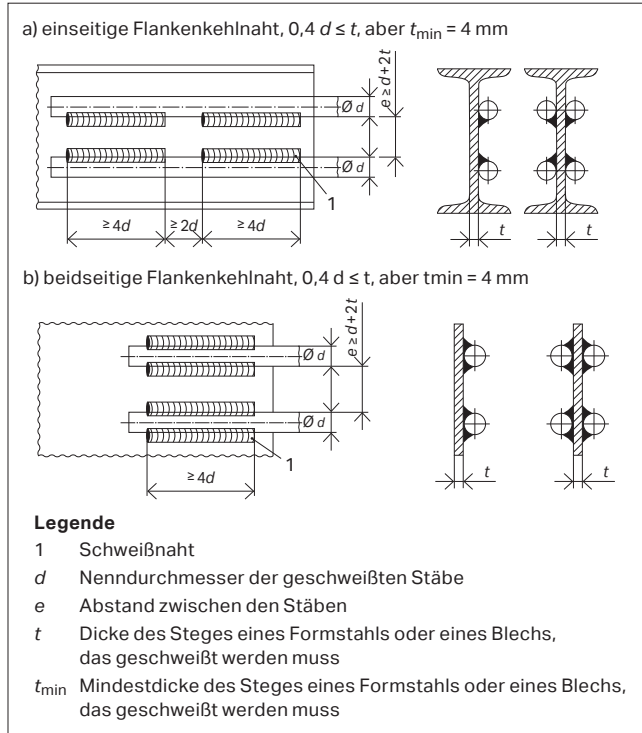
Geschweißte Flankenkehlnaht nach Kap. 6.6.2.1 – Bild 6
